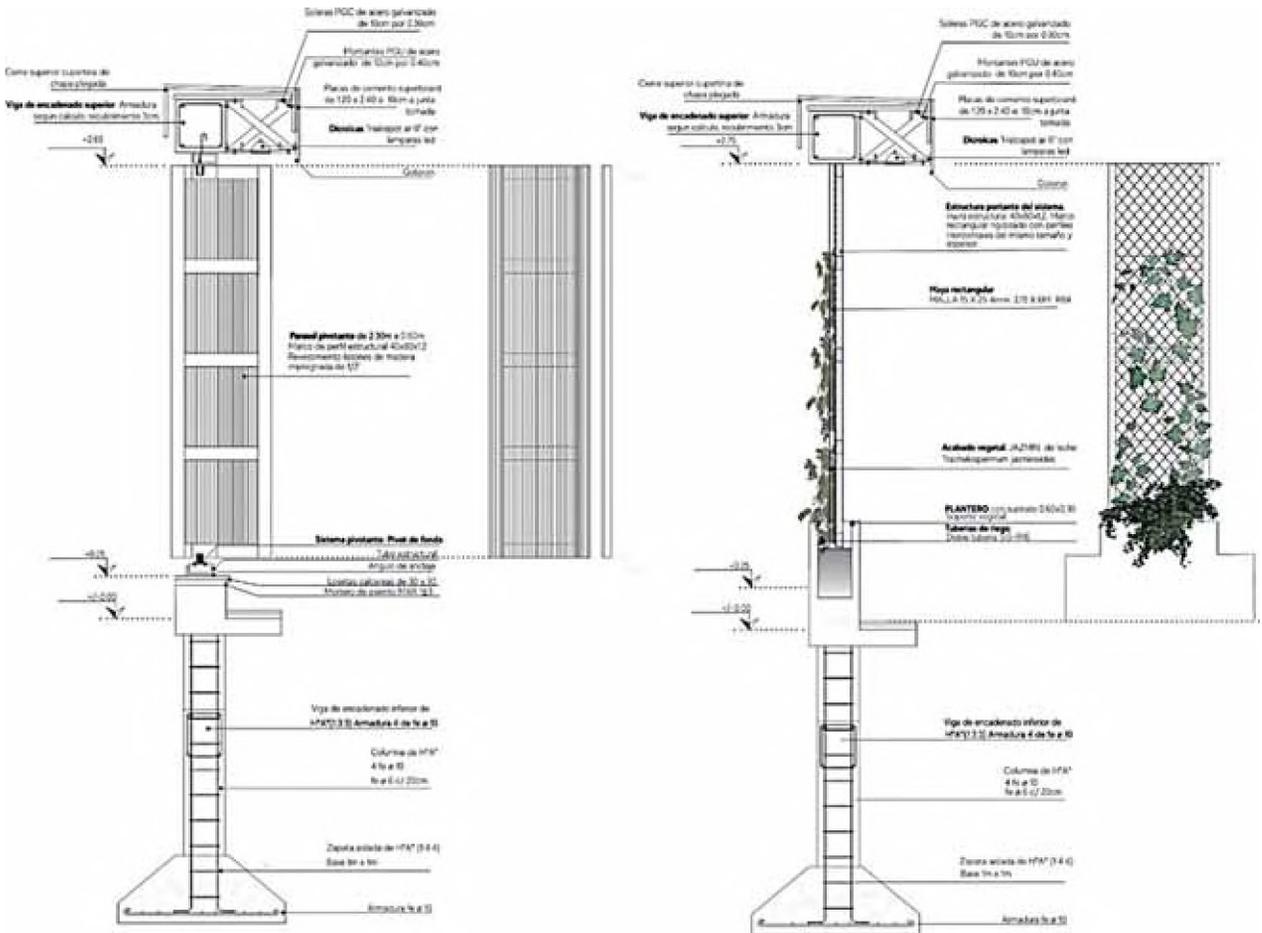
Detalles constructivos de propuesta de parasoles pivotantes y pared verde, de elaboración propia
